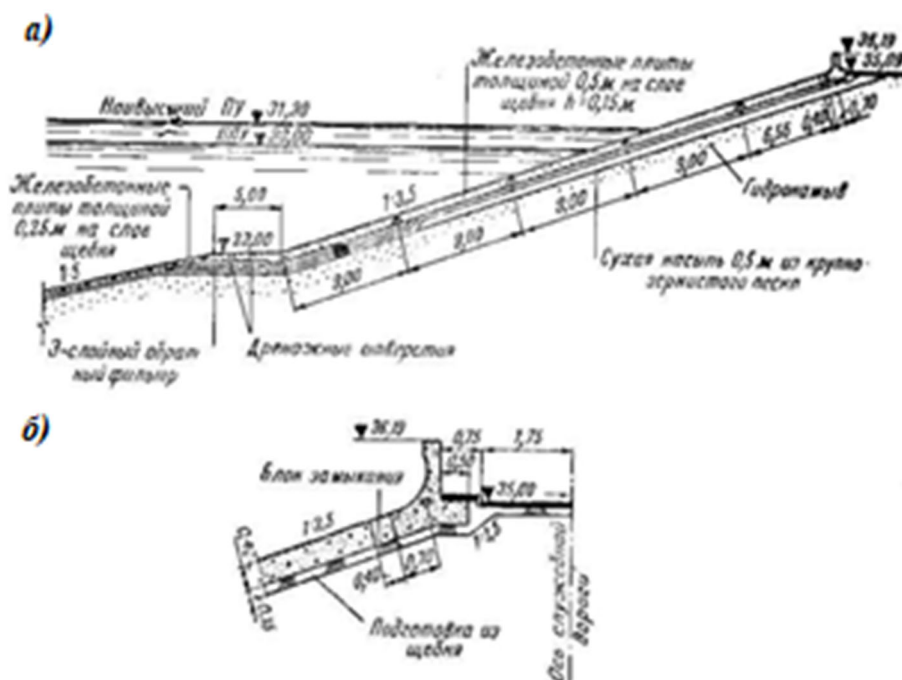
Пример конструкции откосного крепления из железобетонных плит на подготовке: а – типовой разрез; б – парапет [31]
